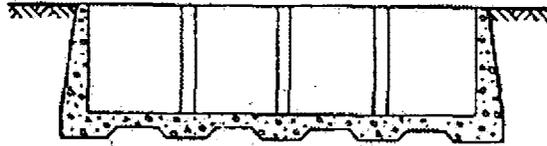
Piso de basamento proyectado para cargas de superestructuras ligeras.
